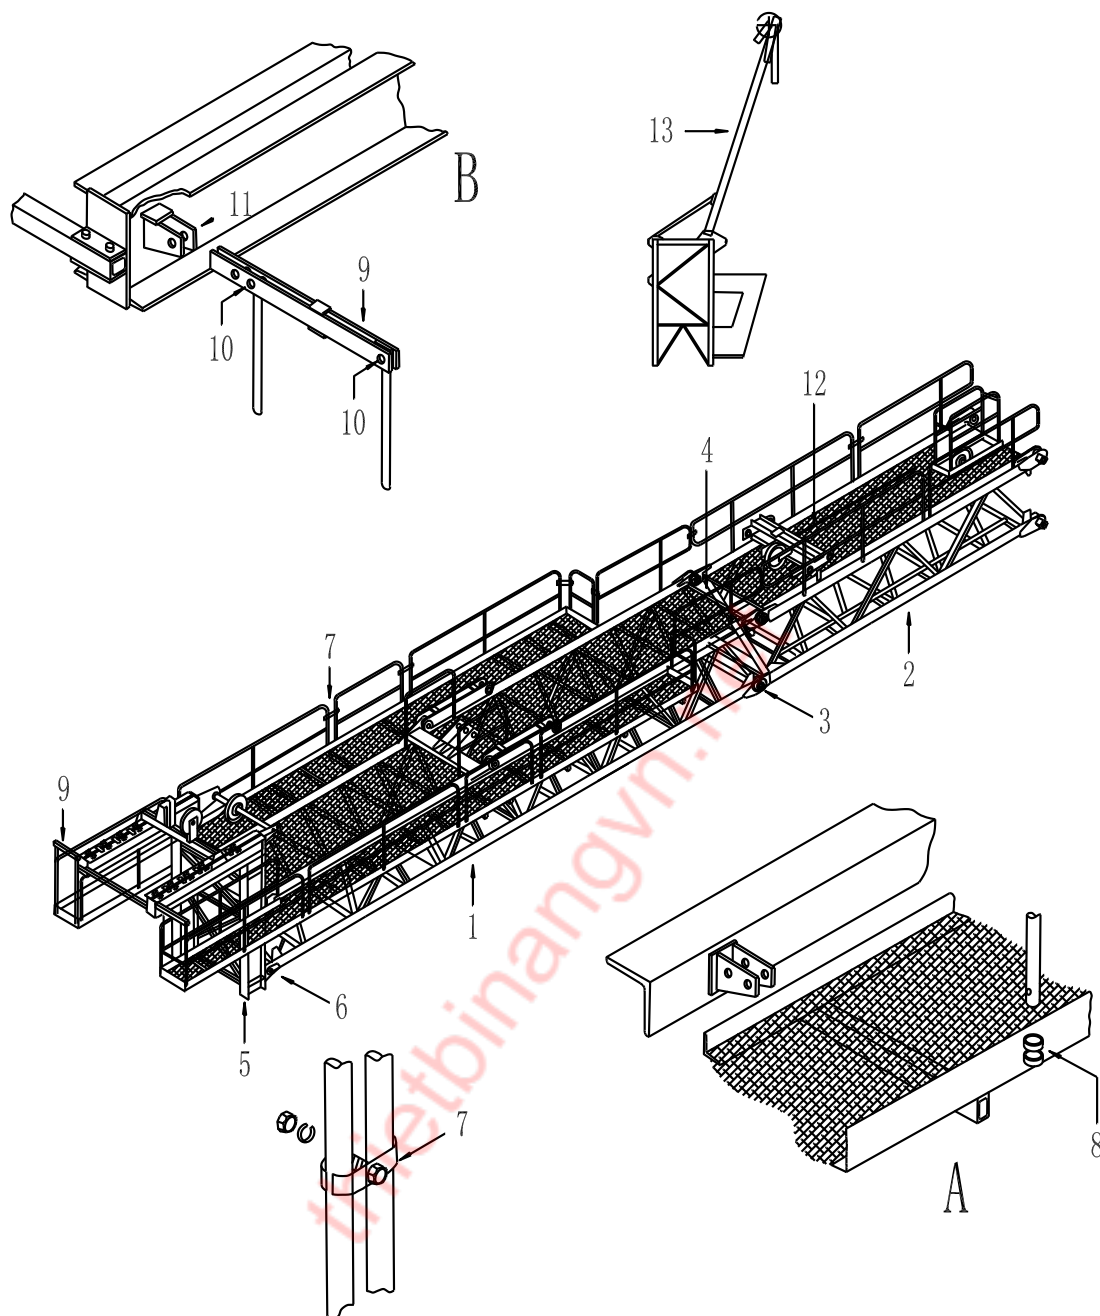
吊装准备 Fig. 4-29 Preparing the complete counter-jib
